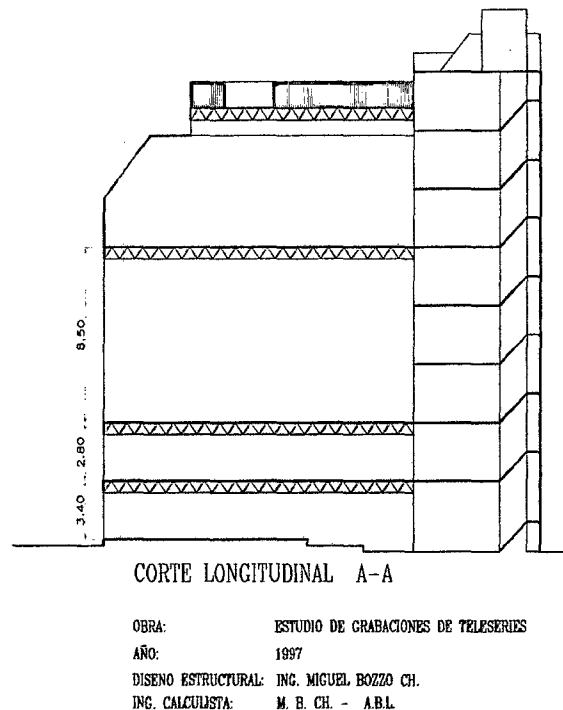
Planta los 2 últimos pisos del Canal 4 – Elevación del Proyecto con E.E.C.
